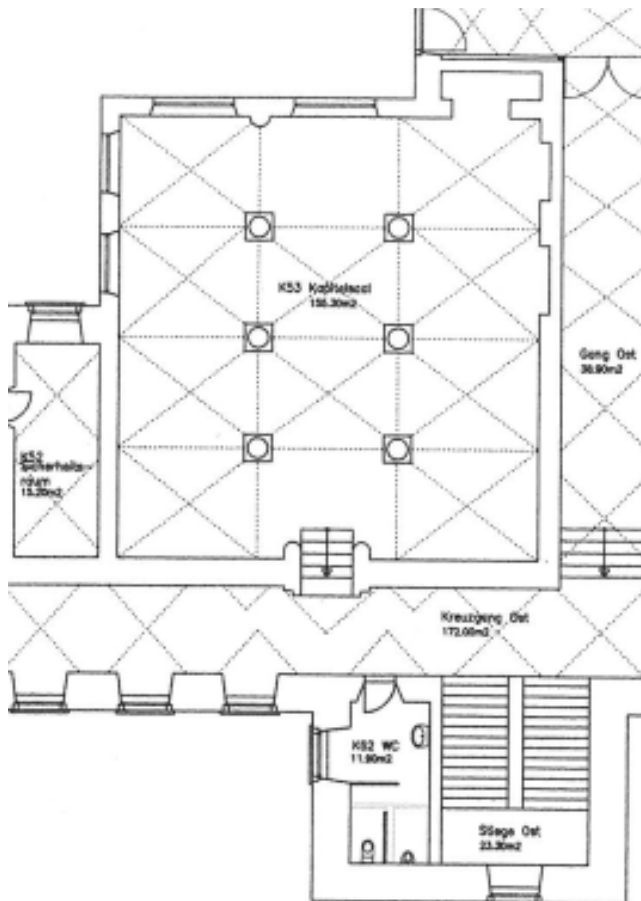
Stift Wettingen-Mehrerau, Kapitelsaal, Grundriss
